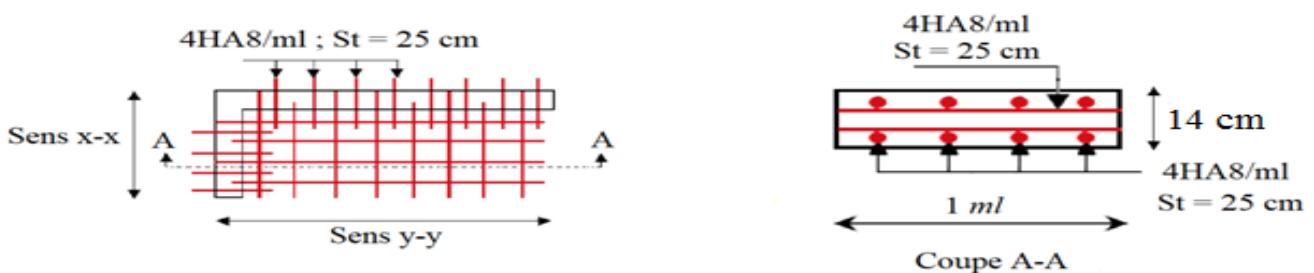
Schéma de ferrailage de la dalle sur deux appuis (type 1)
